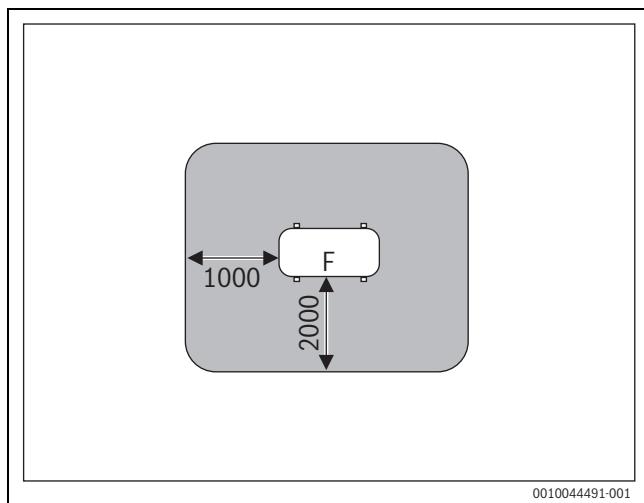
Área de proteção com instalação no chão na propriedade ou no telhado (dimensões em mm)
